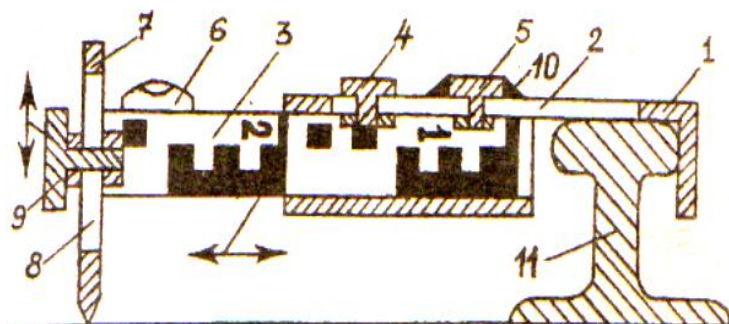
Приспособление для бокового нивелирования с подвижной рейкой
